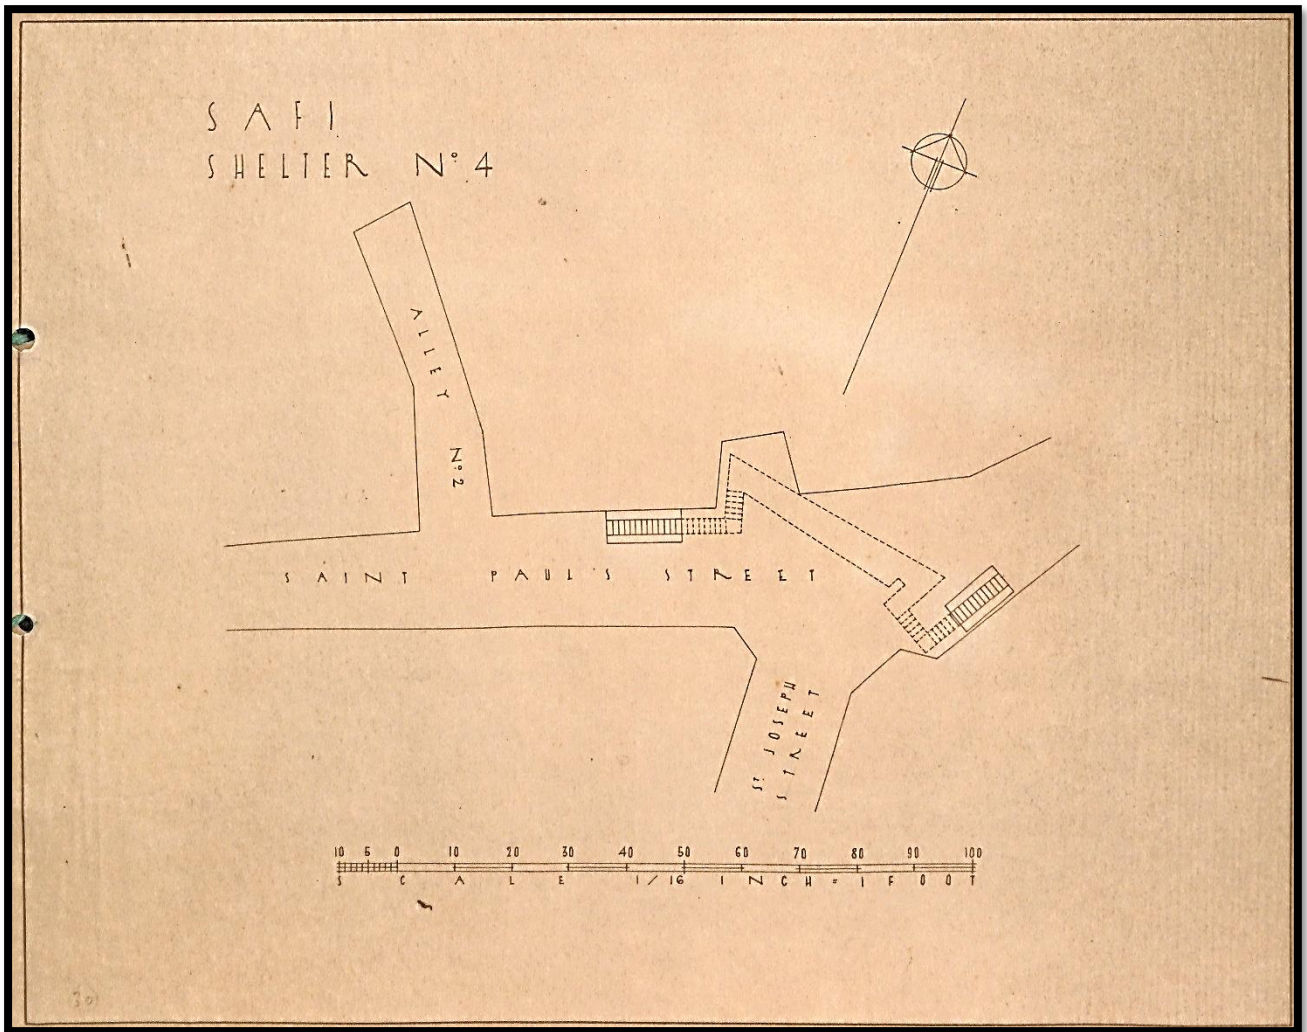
Planta do Abrigo nº4 "Saint Paul's Street* – Alley nº2 – St. Joseph Street."
